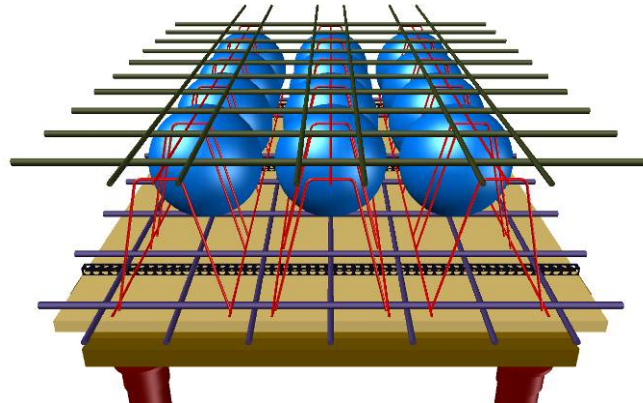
Deckenaufbau der zweiachsigen Hohlkörperdecke mit eingebauten Cobiax-Körben vor der Betonage
